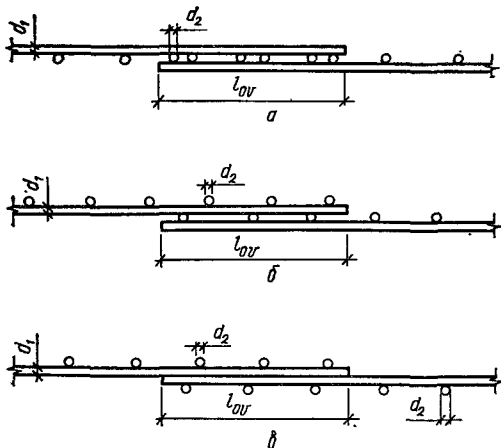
Стыки сварных сеток внахлестку (без сварки) в направлении рабочей арматуры из гладких стержней:
